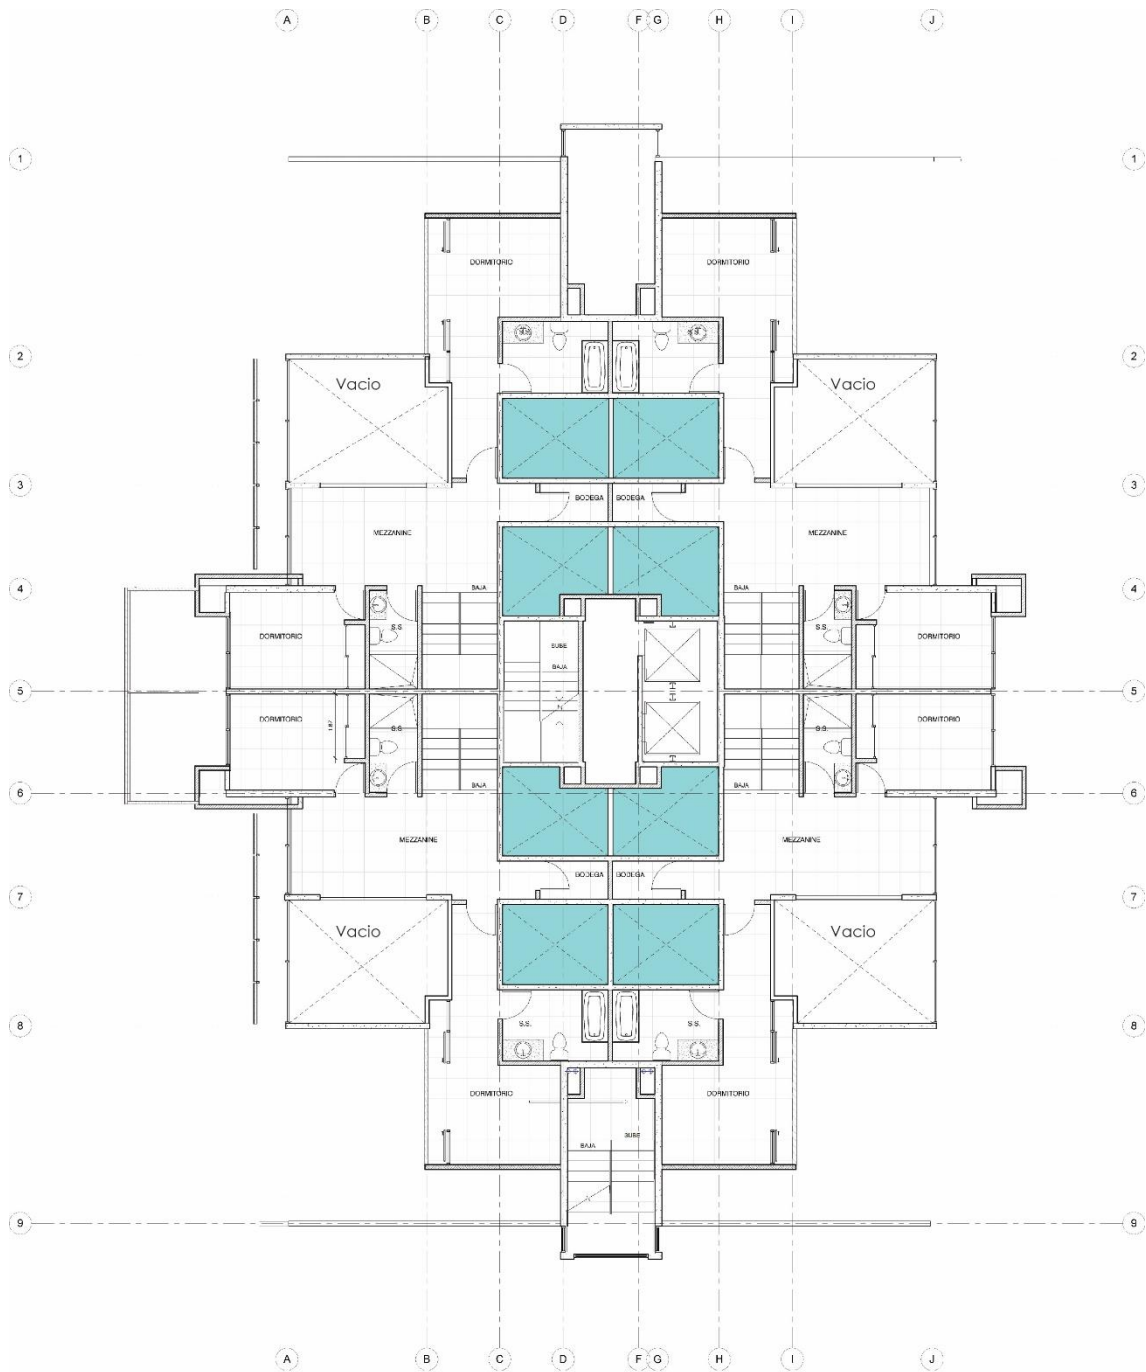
Rediseño de Planta Arquitectónica 1º Nivel de Penthouse. Fuente: Elaboración propia
